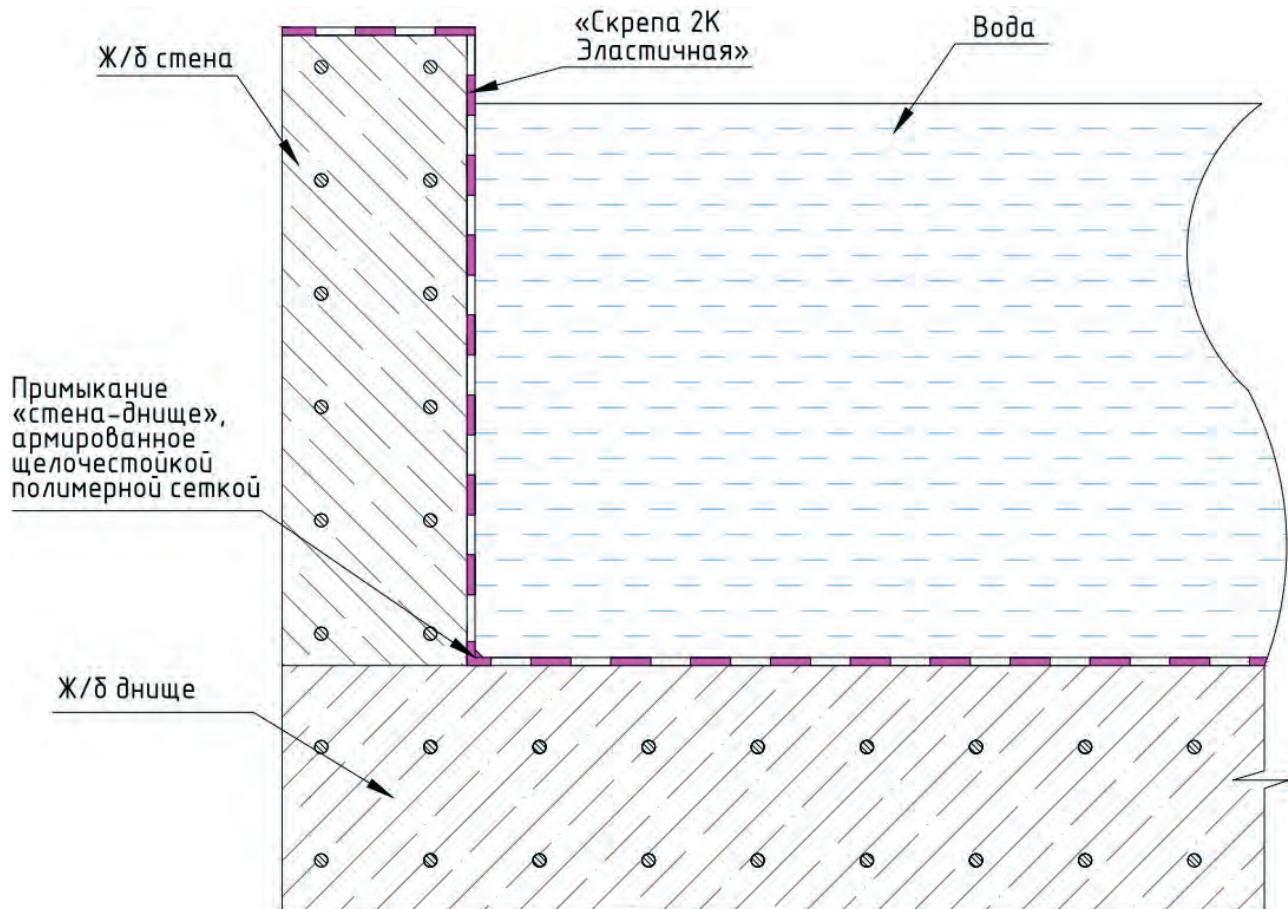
Гидроизоляция наземных монолитных ж/б емкостных сооружений
